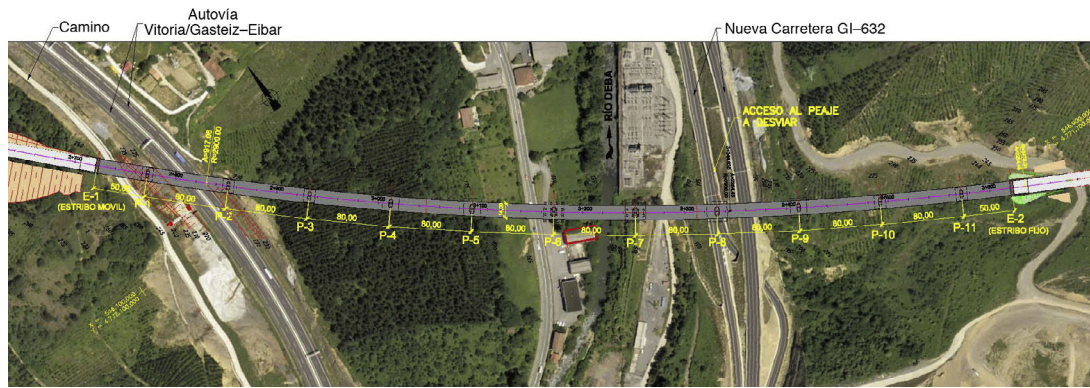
Planta de la solución mixta desarrollada en el proyecto original que proyecta el viaducto en el entorno.
